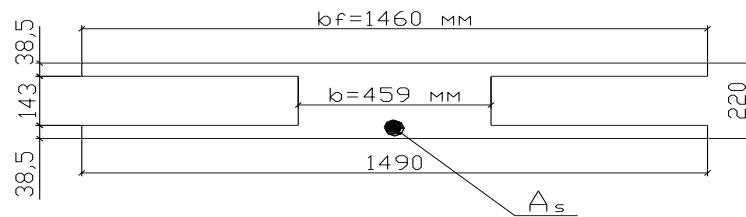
Розрахунок плити перекриття за граничними станами другої групи
